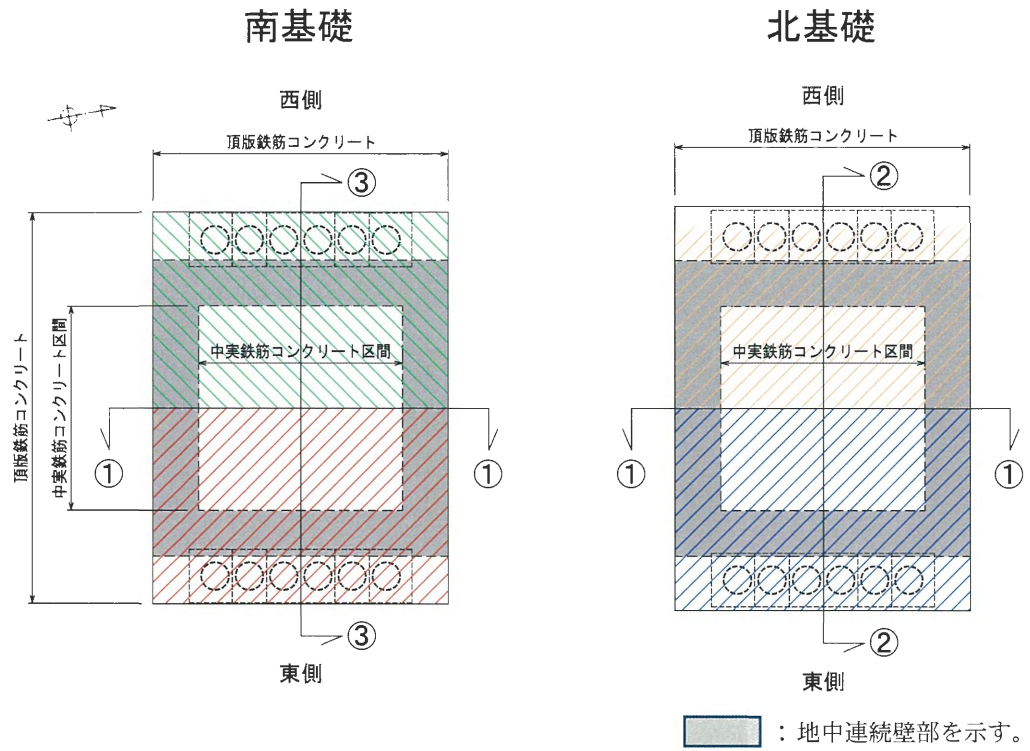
評価位置図（頂版鉄筋コンクリート）
